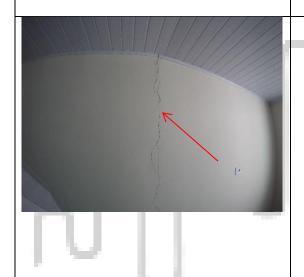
Fissura junto à ampliação executada pelo proprietário.
